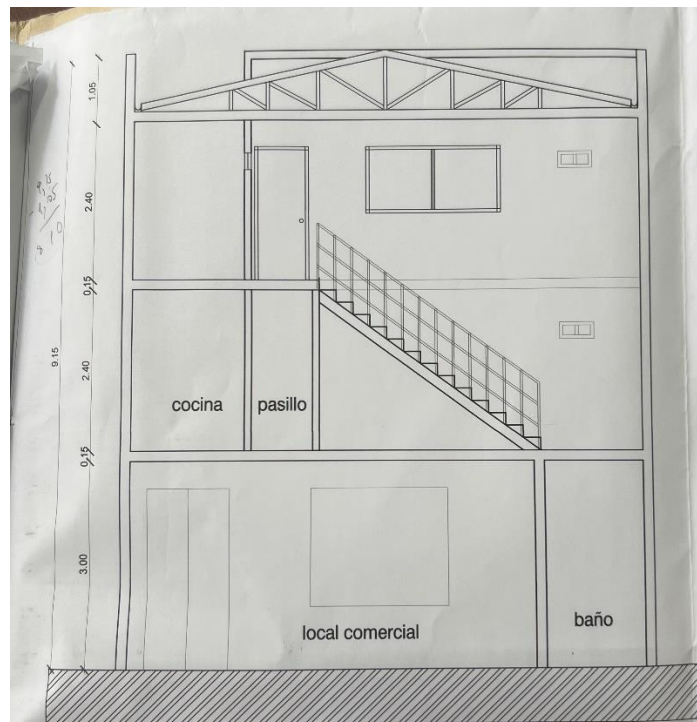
Corte A-A, de la lámina N° 2, del proyecto de arquitectura
